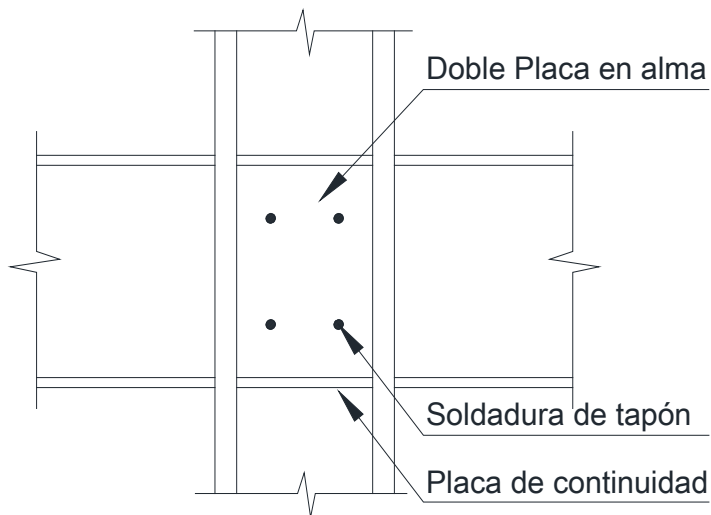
Esquema de ubicación de soldaduras tapón en la zona de panel de un PEM
